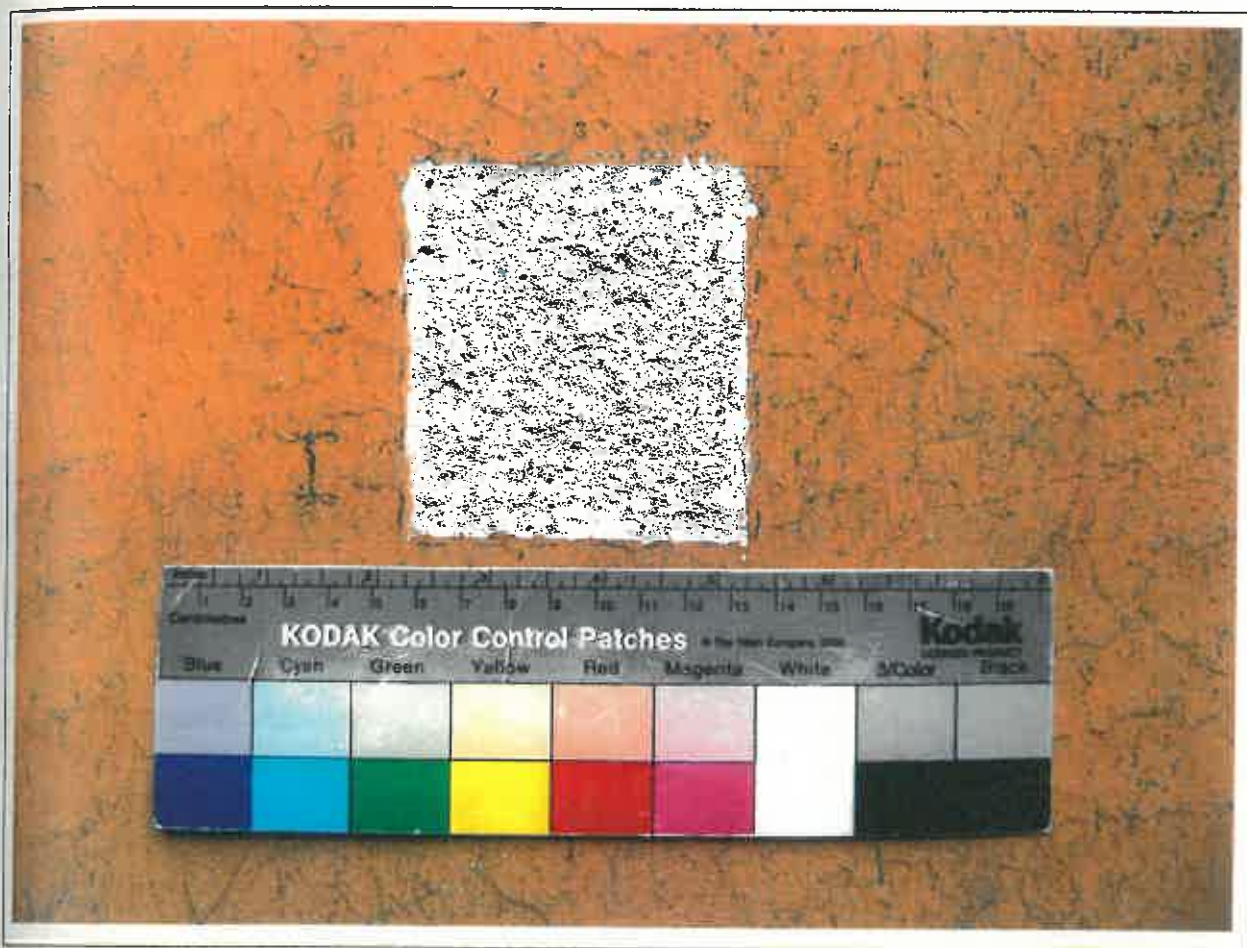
Particolare dello scalone lato Via Verdi con l'ubicazione dei tasselli.
